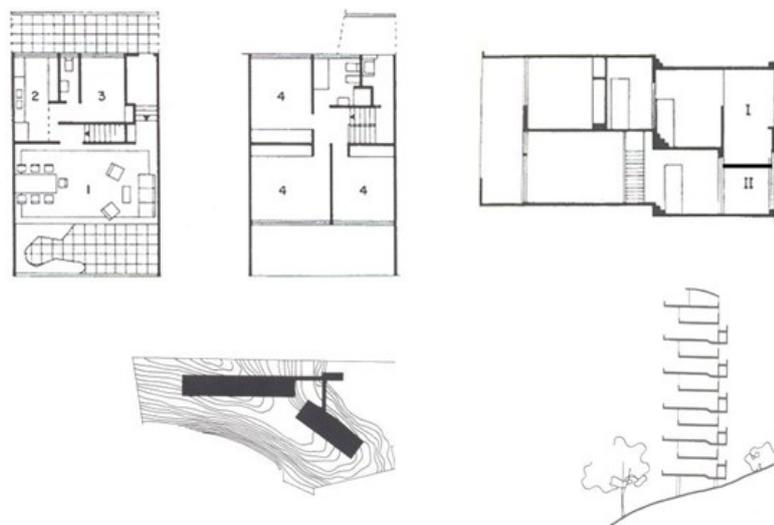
Edifício Julio de Barros Barreto: Plantas e Corte do Apartamento, Situação e Corte Esquemático (fonte: MINDLIN, 2000).
